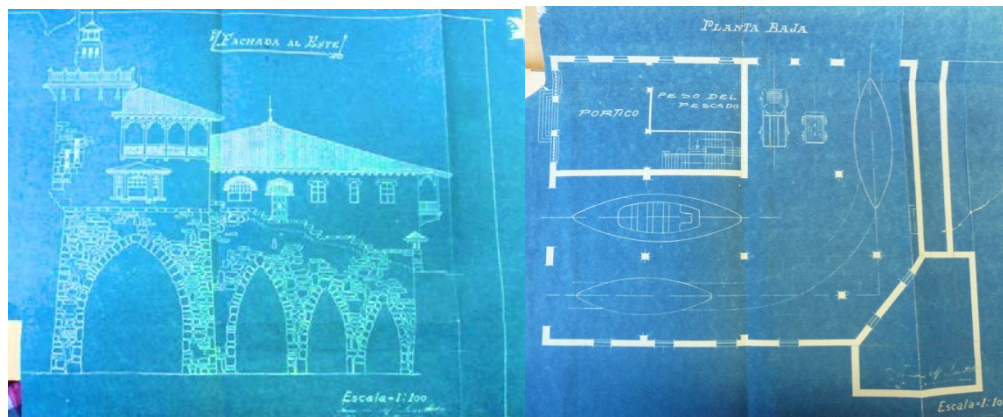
Planos de proyecto: fachada Este y planta baja [2]
